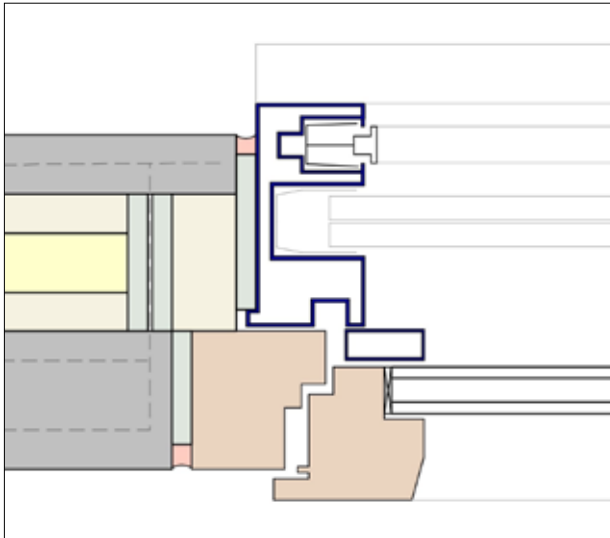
Fassaden-Sandwichelemente (FSE), Einbindung Fenster/ Sonderelement Absturz- siche- rung und Sonnenschutz (kbp)
